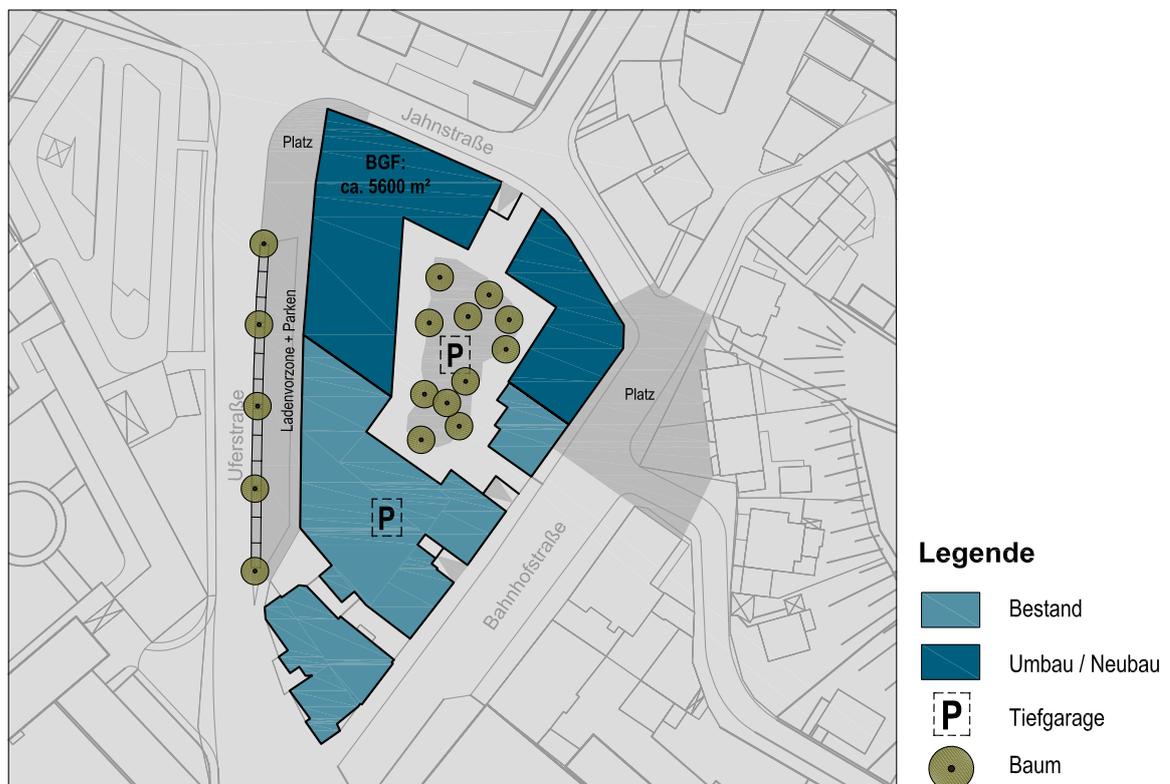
schematisches Bebauungsbeispiel „Blockrand“ des Baublocks zwischen Bahnhofstraße, Uferstraße und Jahnstraße (eigene Darstellung)
